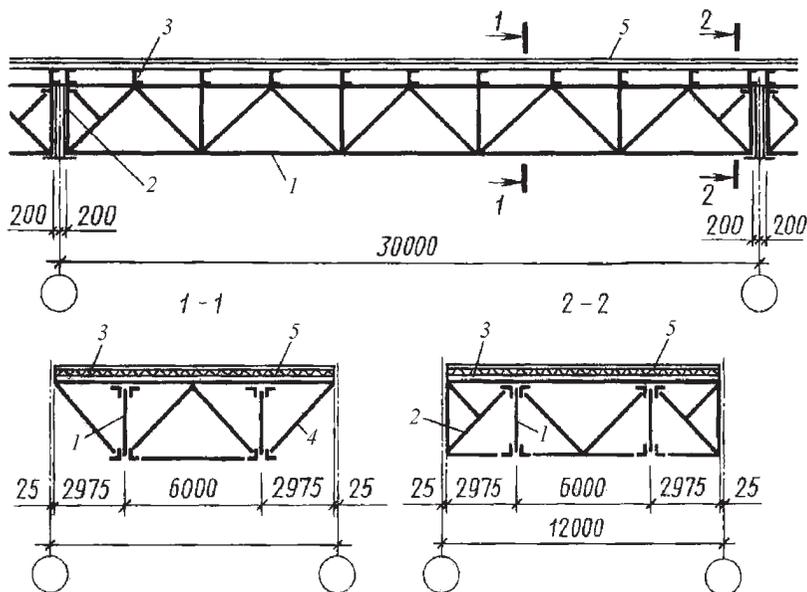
Блок покрытия для поточного монтажа: 1 – стропильная ферма; 2 – подстропильная ферма; 3 – прогон; 4 – контрфорс; 5 – профилированный настил с утеплителем и кровельным ковром
